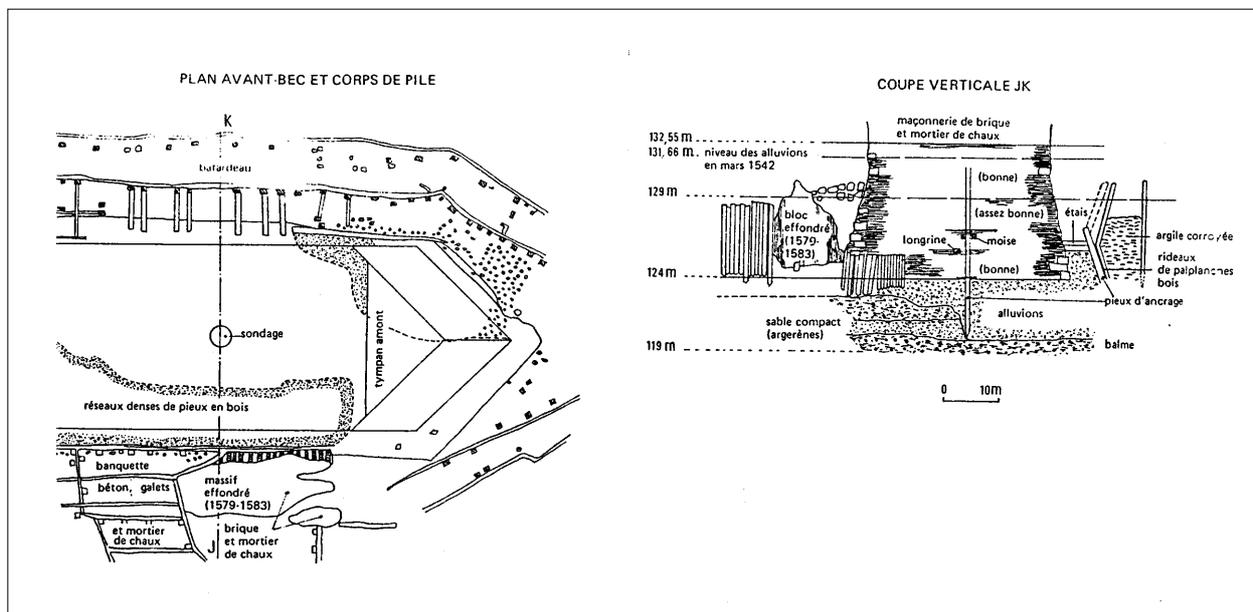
PLAN ET COUPE DE LA 6^e PILE (n° 2 actuelle), d'après R. Lotte, pl. 7.
